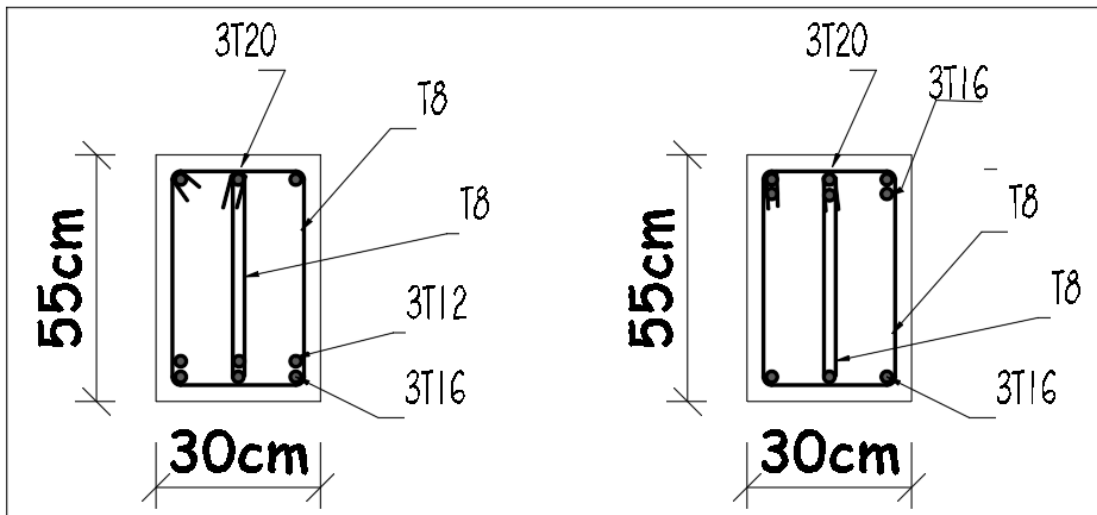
Ferraillage de la poutre principale du 1^{er} au 2^{ème}
